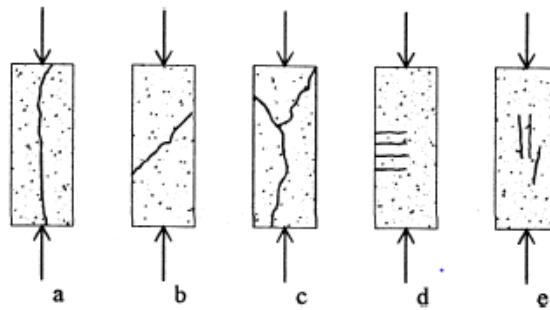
(a, b, c) tipo de fisuras en elementos más esbeltos, (d) fisura por pandeo y C son cuando las cargas están en orden de 85% y 90%
